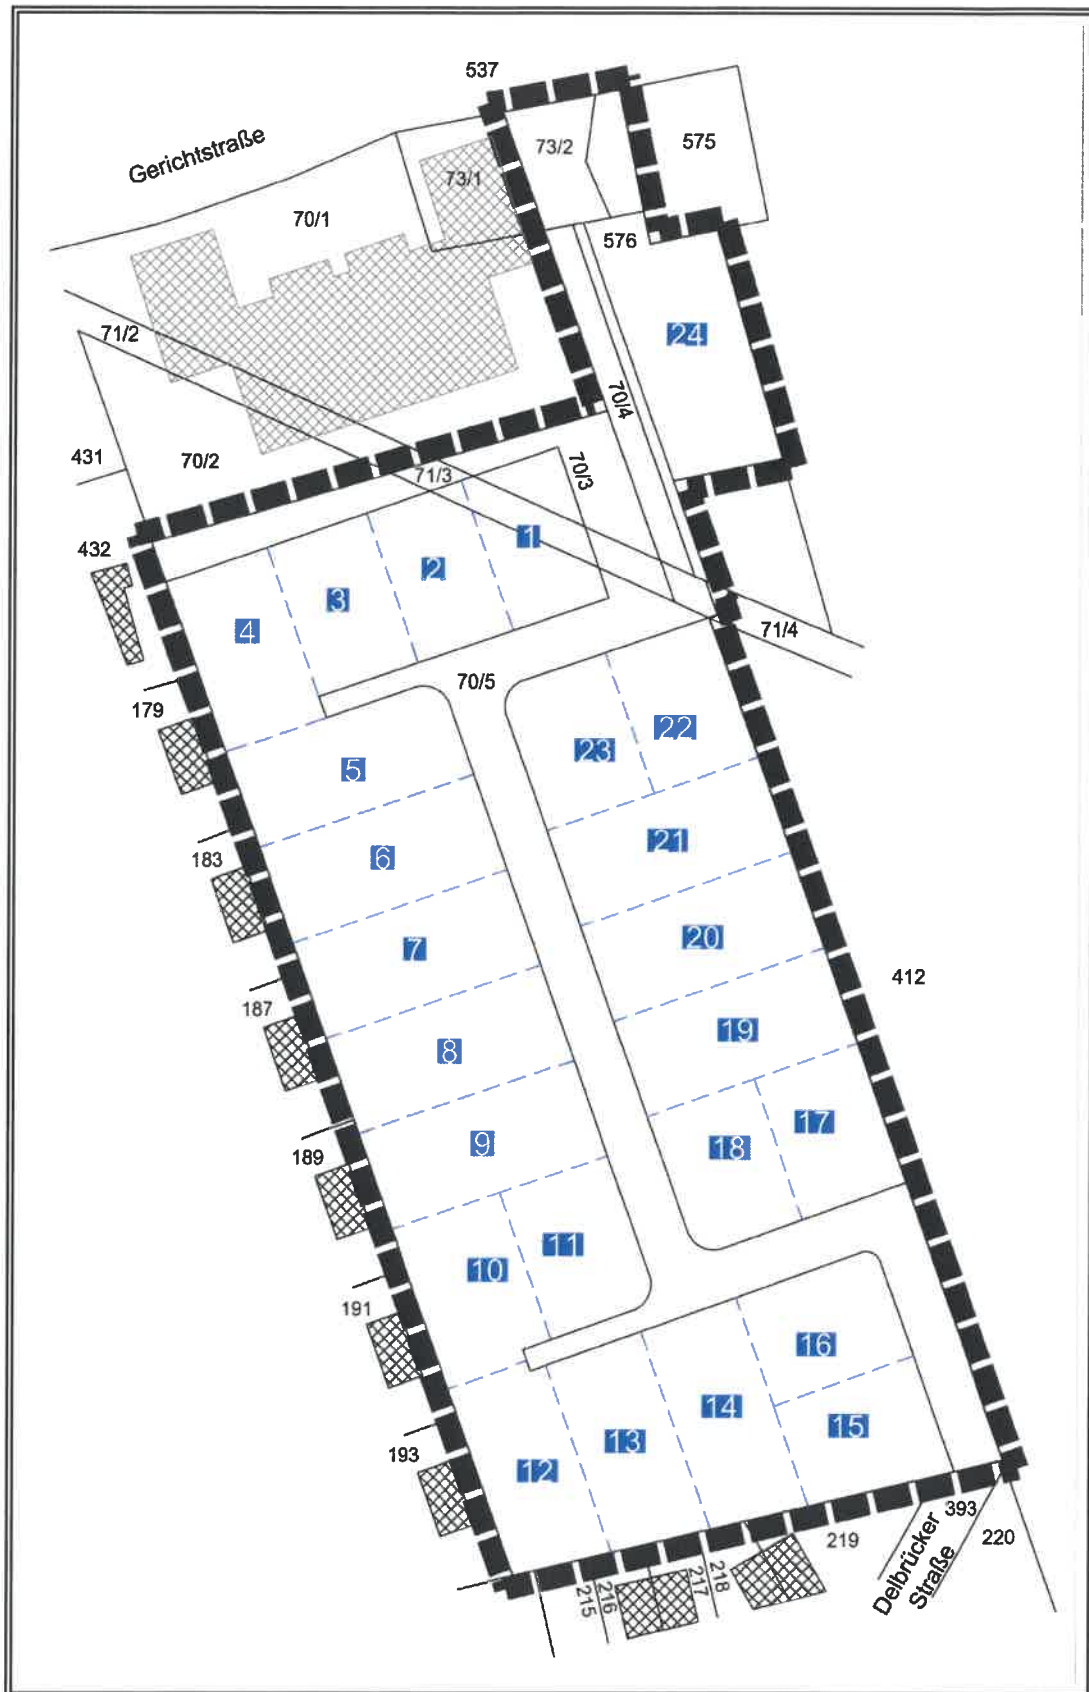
Lage und Nummerierung möglicher Baugrundstücke
